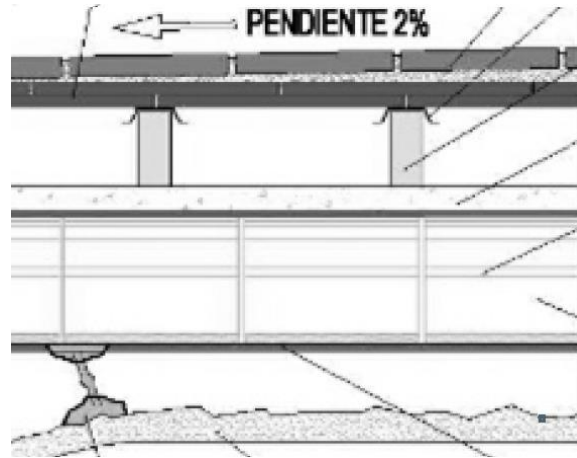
detalle cubierta plana con forjado metálico. Fuente: Abasolo, 2015,
